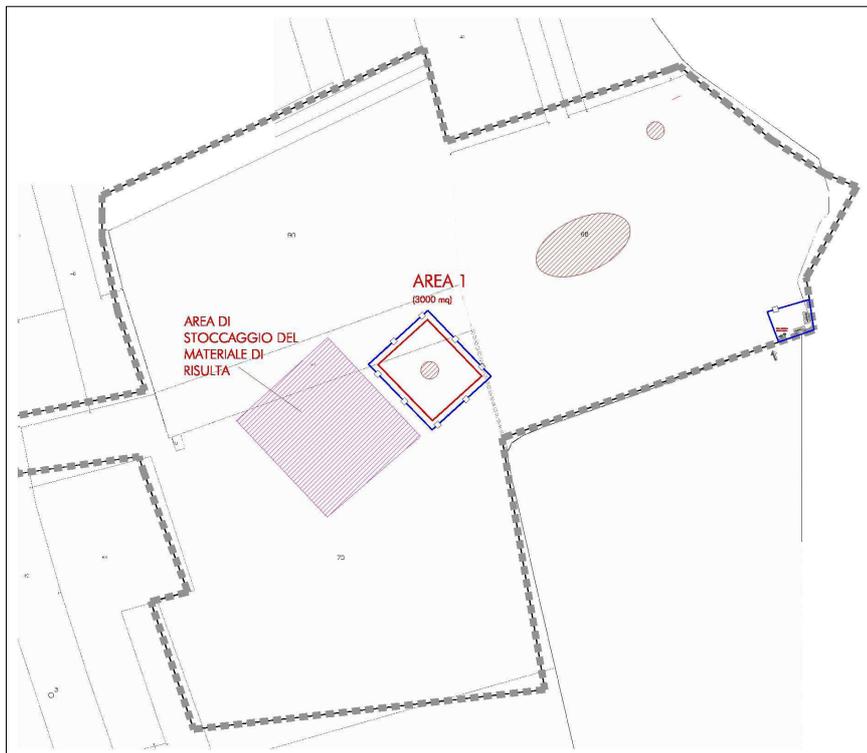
Planimetria generale della prima fase di intervento – Area 1
